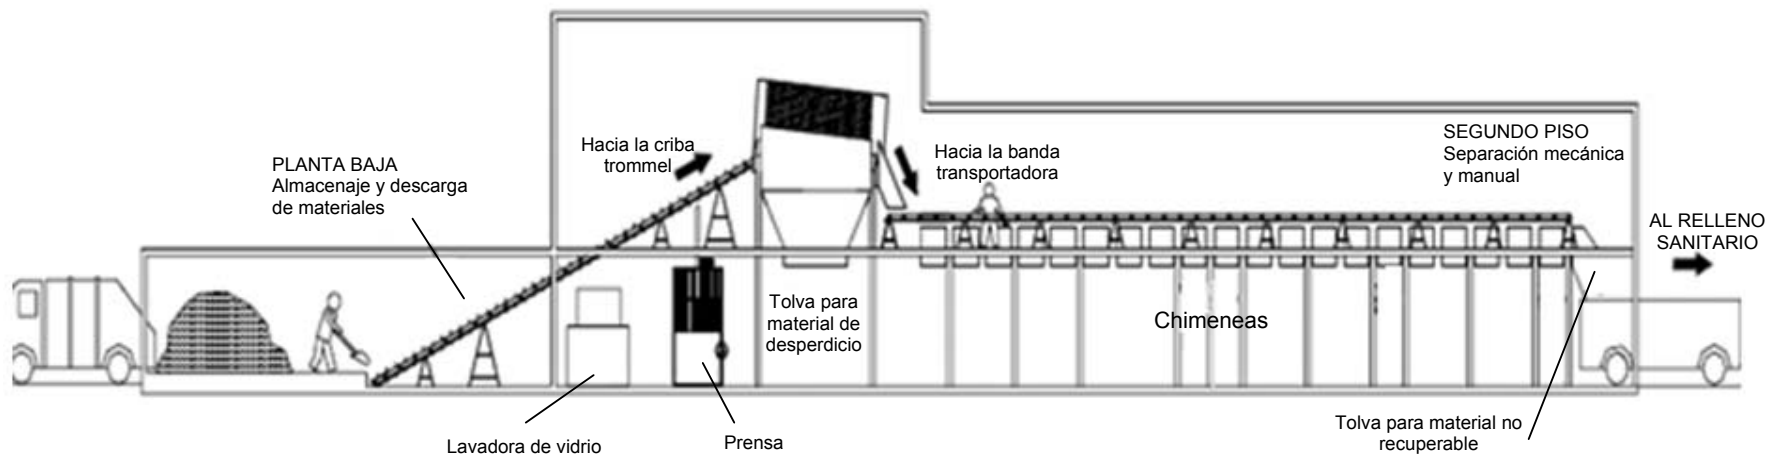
Planta de reciclaje (instalación en dos pisos)
